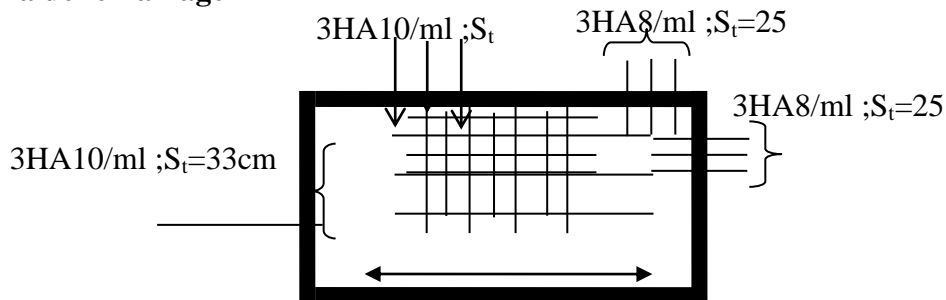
Schéma de ferrailage Dalle pleine sur quatre
